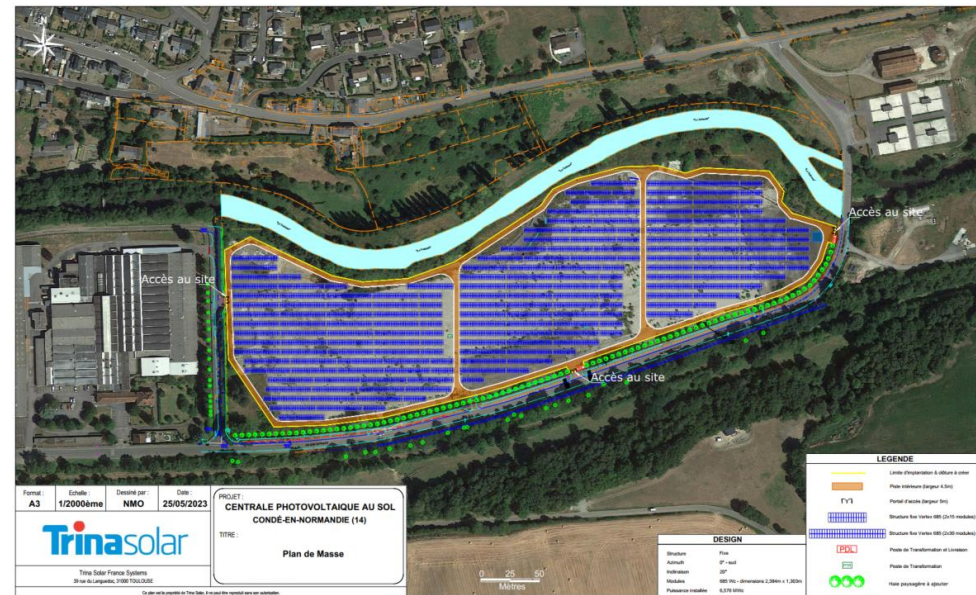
Variante V3 du plan d'implantation (Source : Trina Solar)
